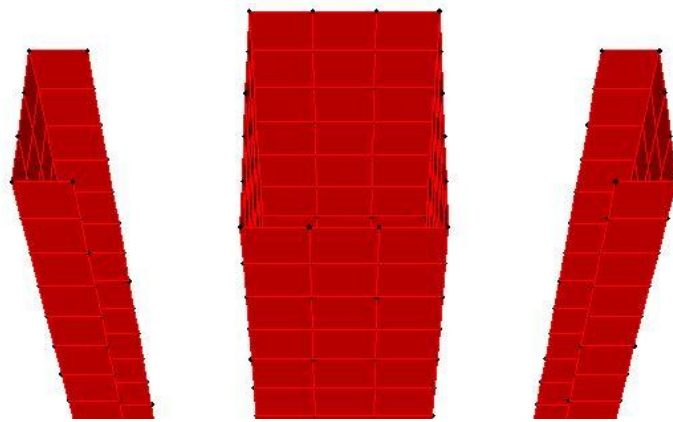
Vista em planta, até ao 37º piso, do núcleo central sem aberturas e dos laterais
